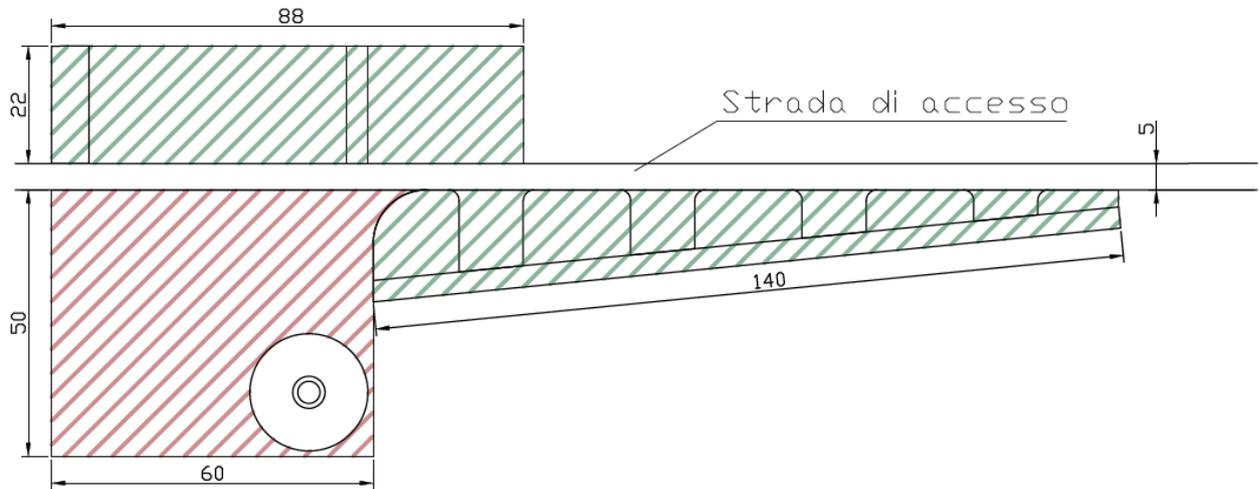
Tipico piazzolo di cantiere con quote espresse in metri
